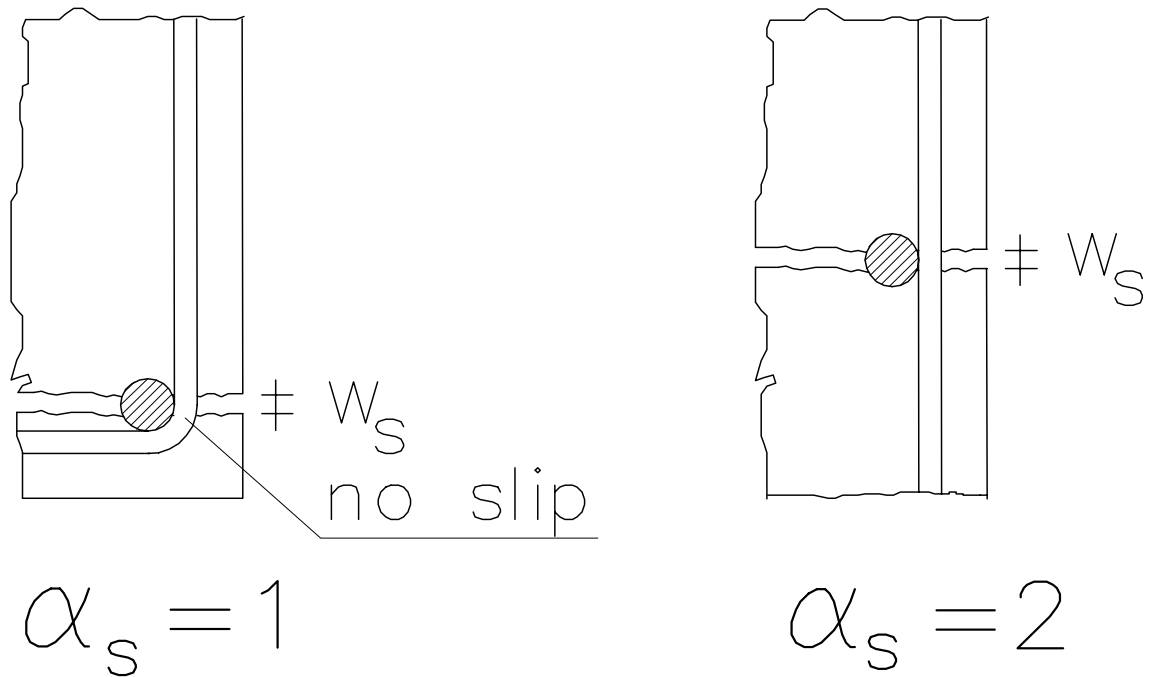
Posizione dell'armatura principale rispetto all'armatura trasversale.
